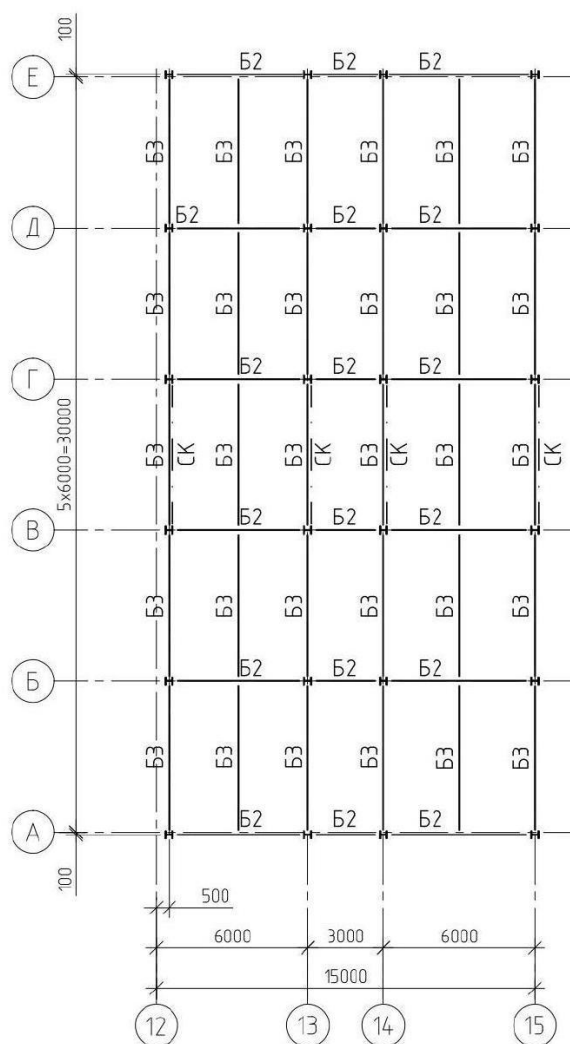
Схема розташування конструкцій перекриття на відм. +3,900
